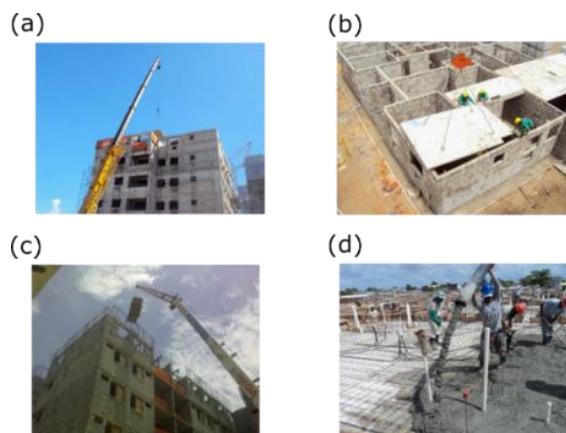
(a) Içamento de lajes maciças pré-moldadas, (b) montagem da laje maciça pré-moldada na edificação, (c) içamento de painéis treliçados e (d) etapa de concretagem das lajes maciças com painéis treliçados.
